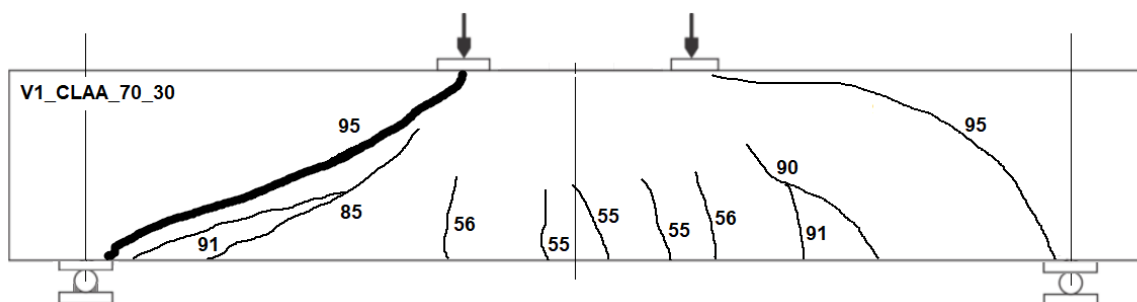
Esquema de fissuração da Viga 1_CLAA_70_30.
